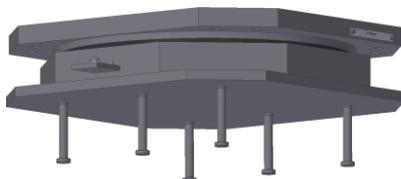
Lagertyp Tf, Stahlschluss oben unten Beton, als Verankerung Kopfbolzen
